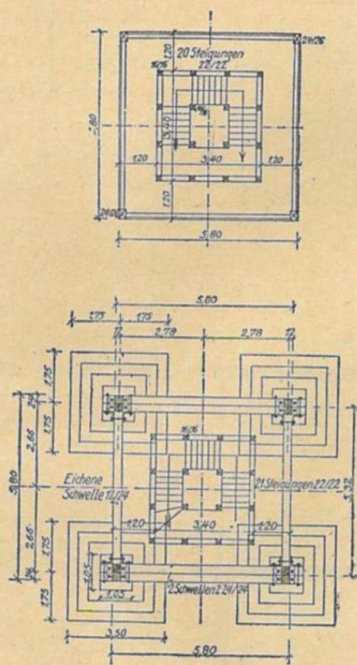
/8. Grundrisse des Turmes in Höhe a—b (unten) und e—f (oben). Maßstab 1 : 200
